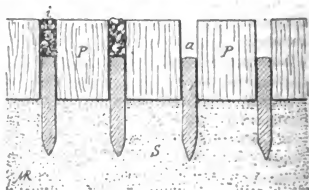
Coupe verticale d'un pavage en bois avec planches.
